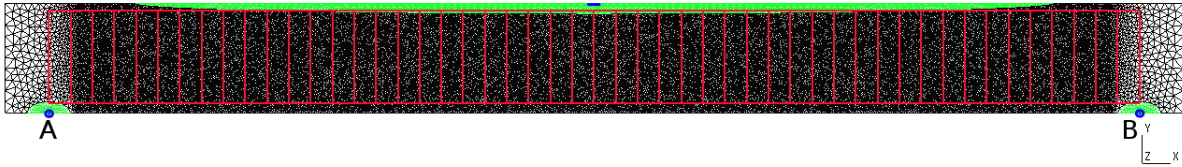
Maillage de la poutre de l'essai CEOS.FR.
